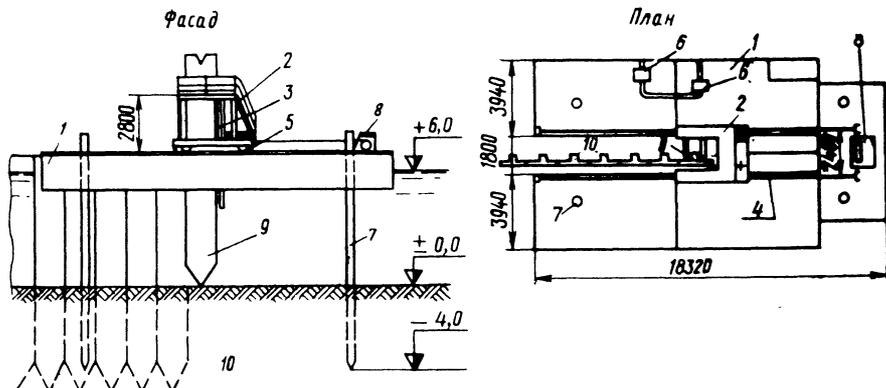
Плавающий кондуктор для погружения таврового железобетонного шпунта:
